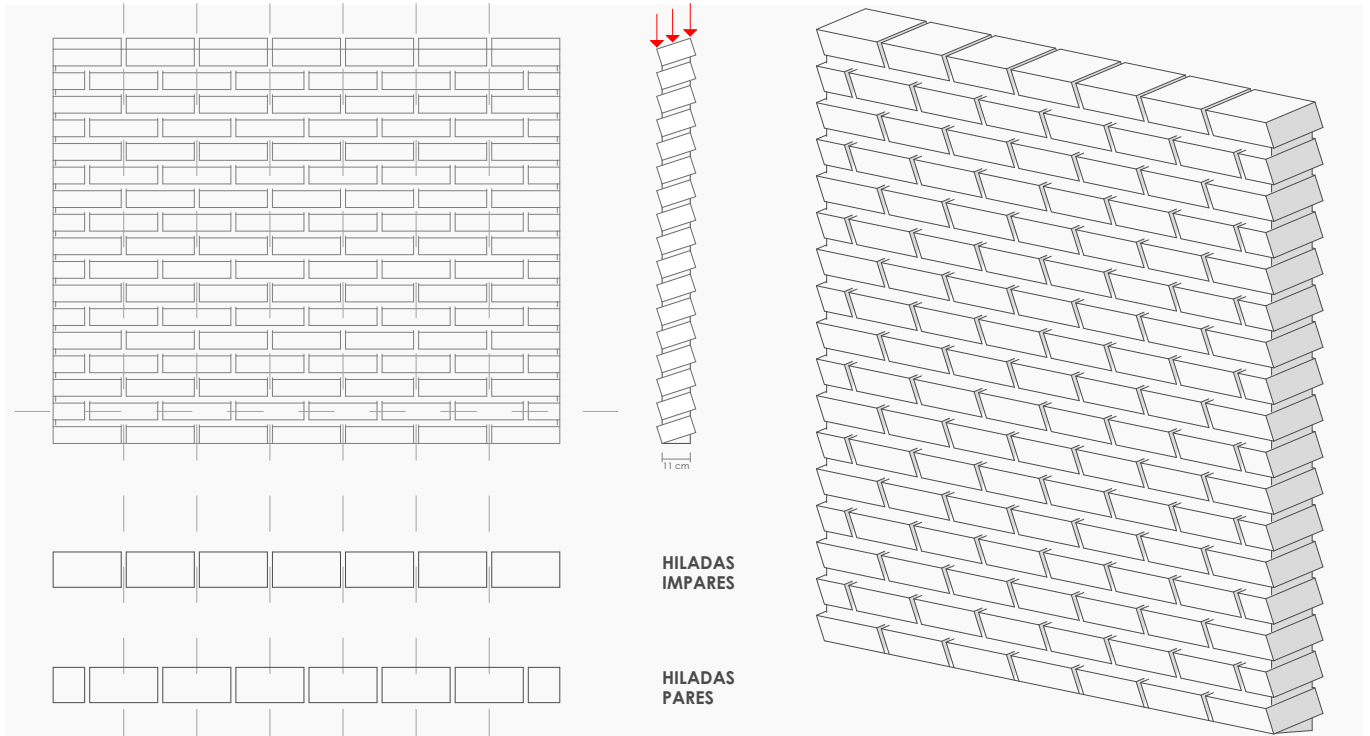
Ilustración del ladrillo en el detalle constructivo 4.
